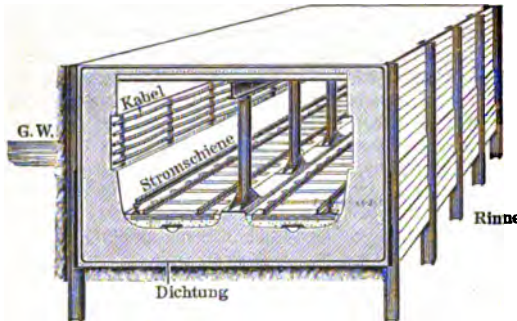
Tunnelstrecke der elektrischen Hoch- und Untergrundbahn zu Berlin im Grundwasser.
